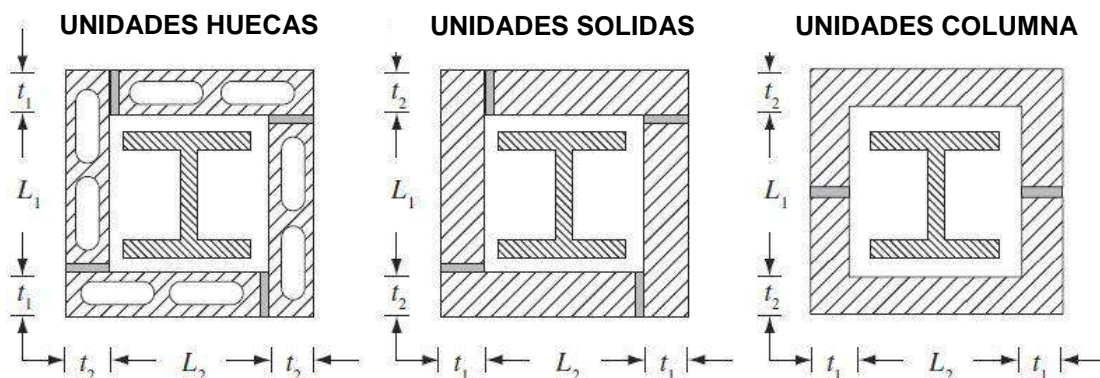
Columnas de acero estructural protegidas con mampostería de concreto
